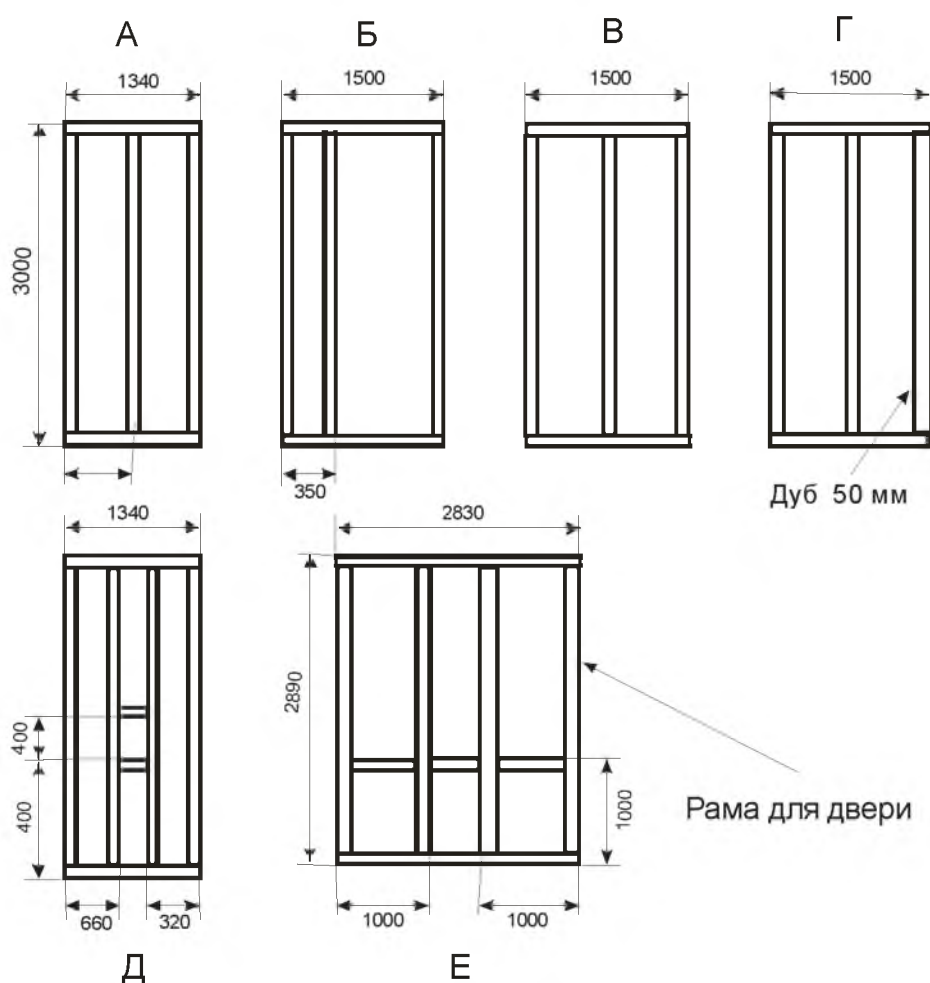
Эскизы рам для изготовления стен, потолка и двери камеры.
